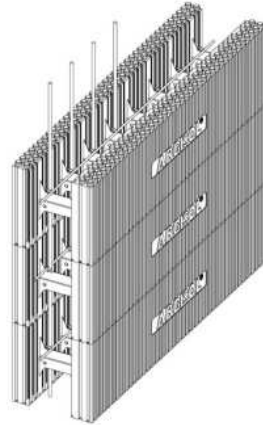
Parede com armadura (ARGISOL, 2010).
